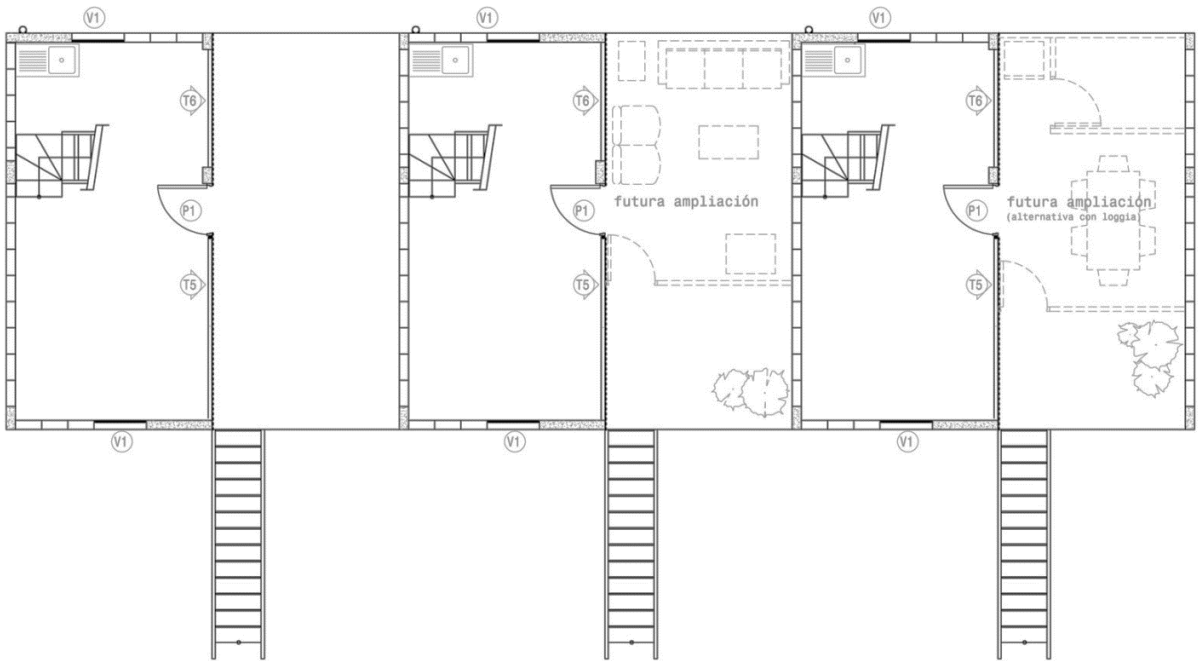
Projeto de arquitetura (planta baixa do 2º pavimento) do Quinta Monroy, Chile
